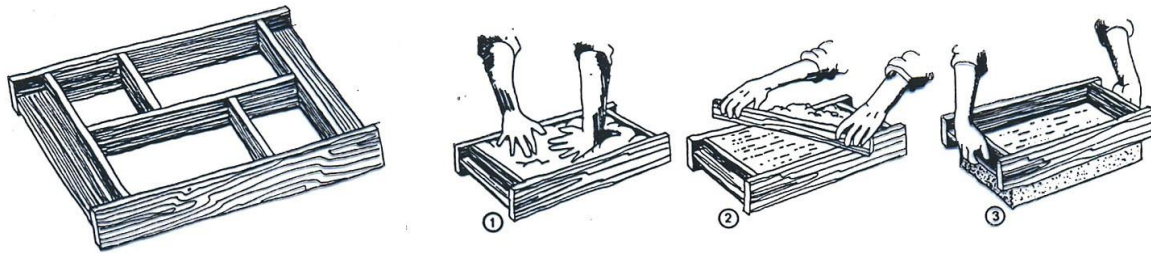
| Técnica de construção | Fonte: www.coisasdaarquitectura.files.wordpress.com
